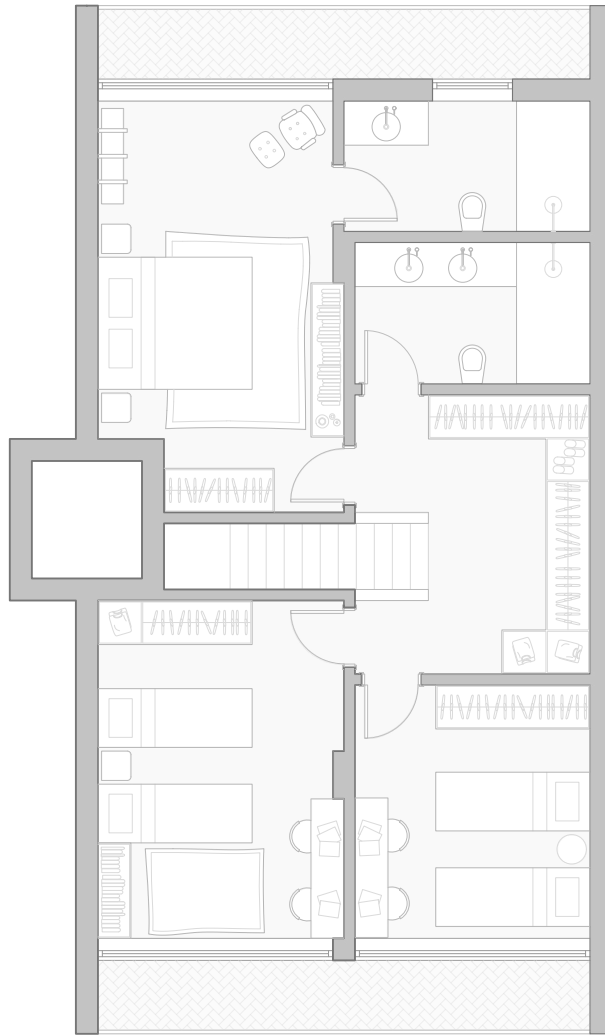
Planta T3 2x1 Piso Superior 1:100
